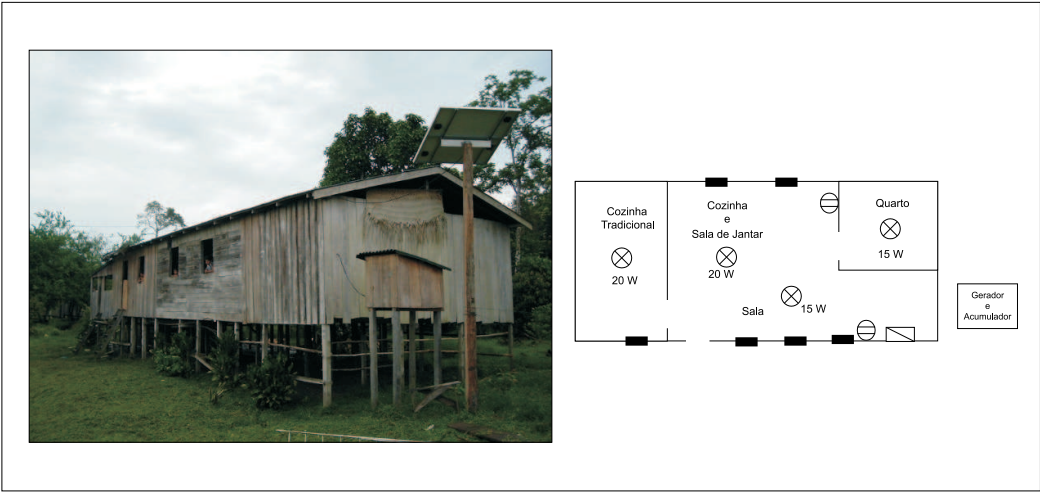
Vista externa do SFD19 e planta aproximada do domicílio.
